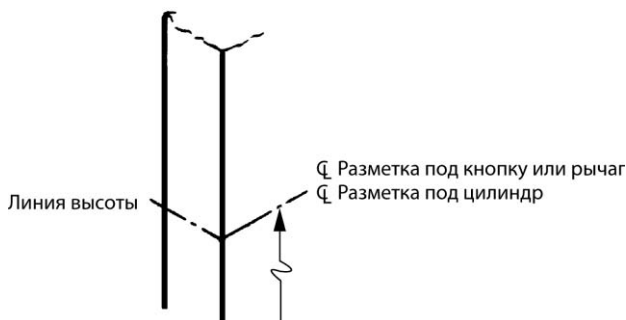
Горизонтальная разметка (С разрешения компании Schlage Lock Company)
